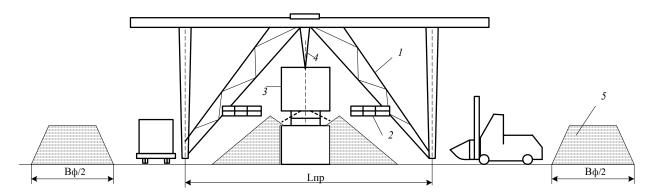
Поперечный разрез склада с повышенным путем, оборудованного козловым краном и ковшовым погрузчиком: *1* – мостом-ферма; *2* – площадка для рабочих; *3* – люкоподъемники; *4* – накладной вибратор; *5* – штабели груза
